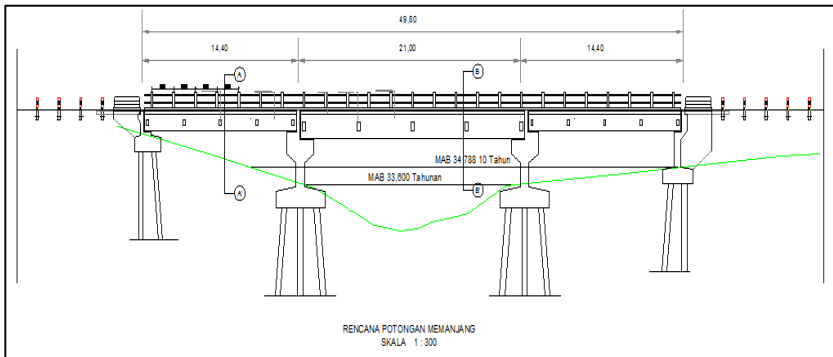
Layout Eksisting Jembatan Kalianyar
